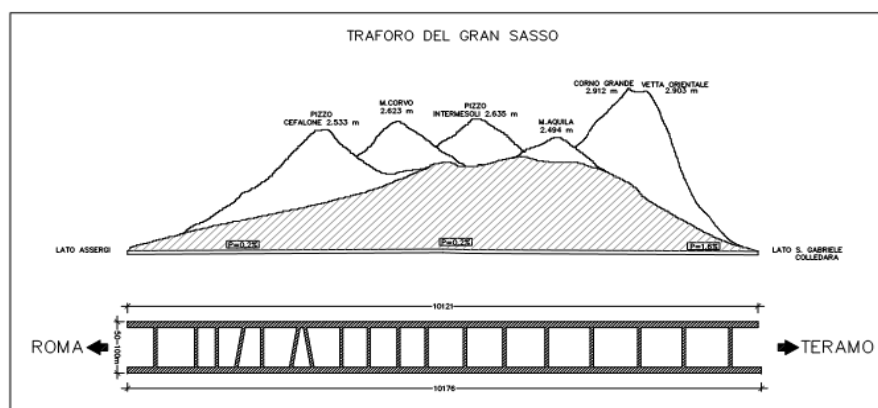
Sezione trasversale e pianta dell'infrastruttura
